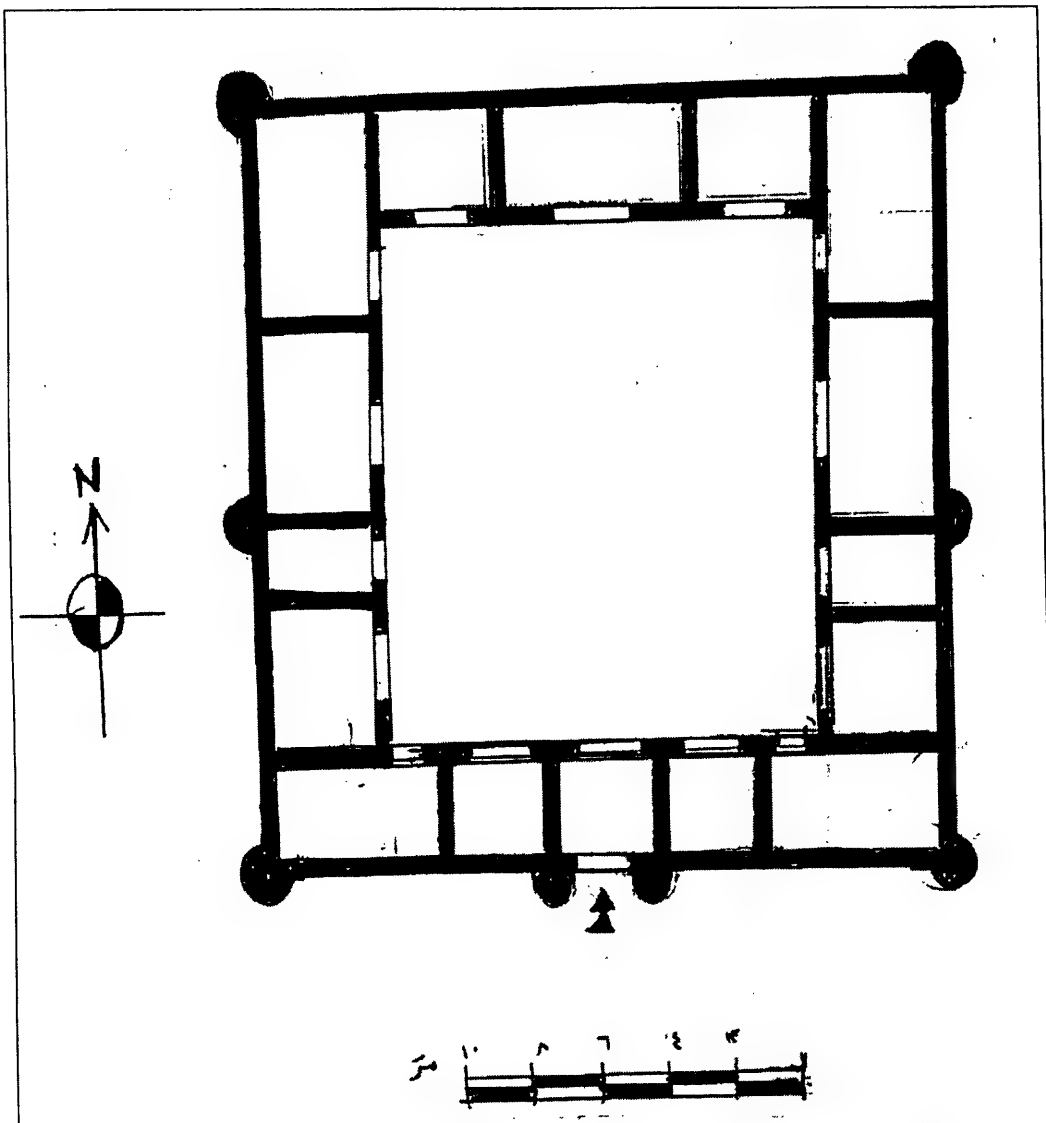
مسقط أفقي لبقايا المبنى السكني (ج). بمدينة الجميرا
